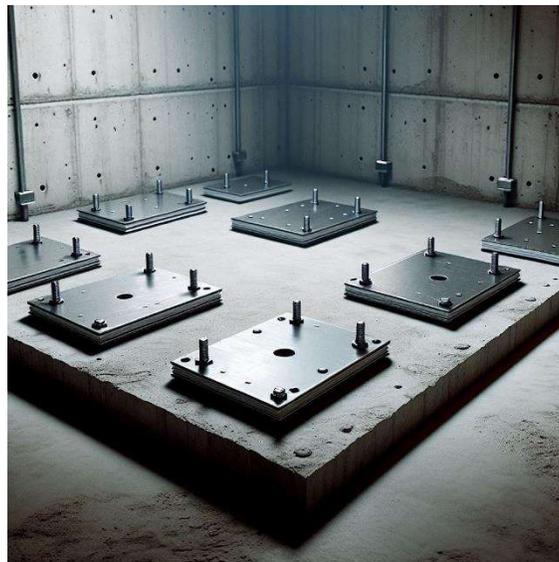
Cimbra posterior al vibrado del concreto (generado con IA)
